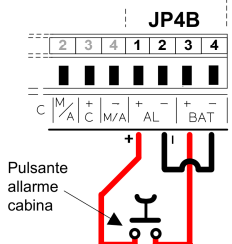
Collegamento pulsante allarme (contatto pulito)
